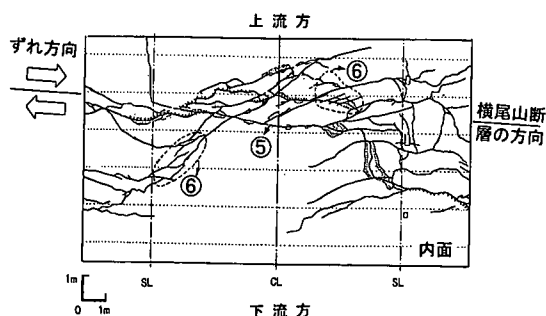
塩屋谷川放水路トンネルのひび割れ展開図
